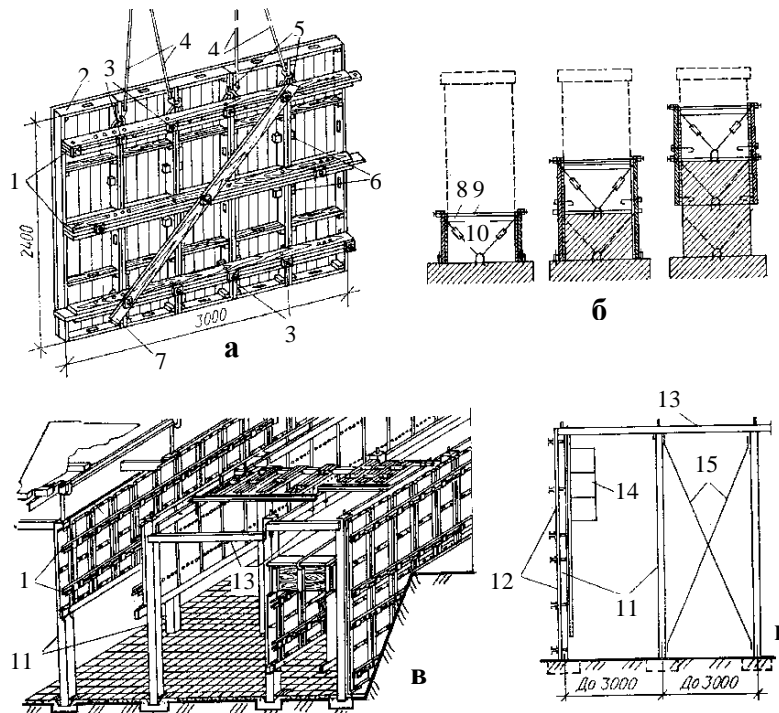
Опалубка масивів і фундаментів під устаткування: а – великорозмірна дерев’яна панель; б – схема переставляння панелей; в – схема встановлення сталеві опалубки фундаменту під технологічне обладнання; г – розставлення залізобетонних стояків каркаса опалубки; 1 – прихватки; 2 – щит палублення; 3 – стяжні болти; 4 – стропи; 5 – монтажні петлі; 6 – дерев’яні клини; 7 – діагональні в’язи; 8 – розпірка; 9 – тяж; 10 – розтяжки; 11 – залізобетонні стояки; 12 – блоки опалубки; 13 – залізобетонні балки; 14 – погінна драбина; 15 – вертикальні в’язи
